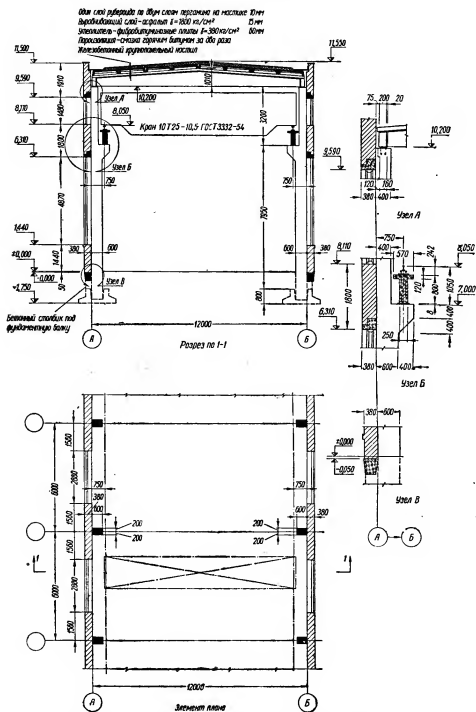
Однопролетное промышленное здание в сборном железобетоне.
